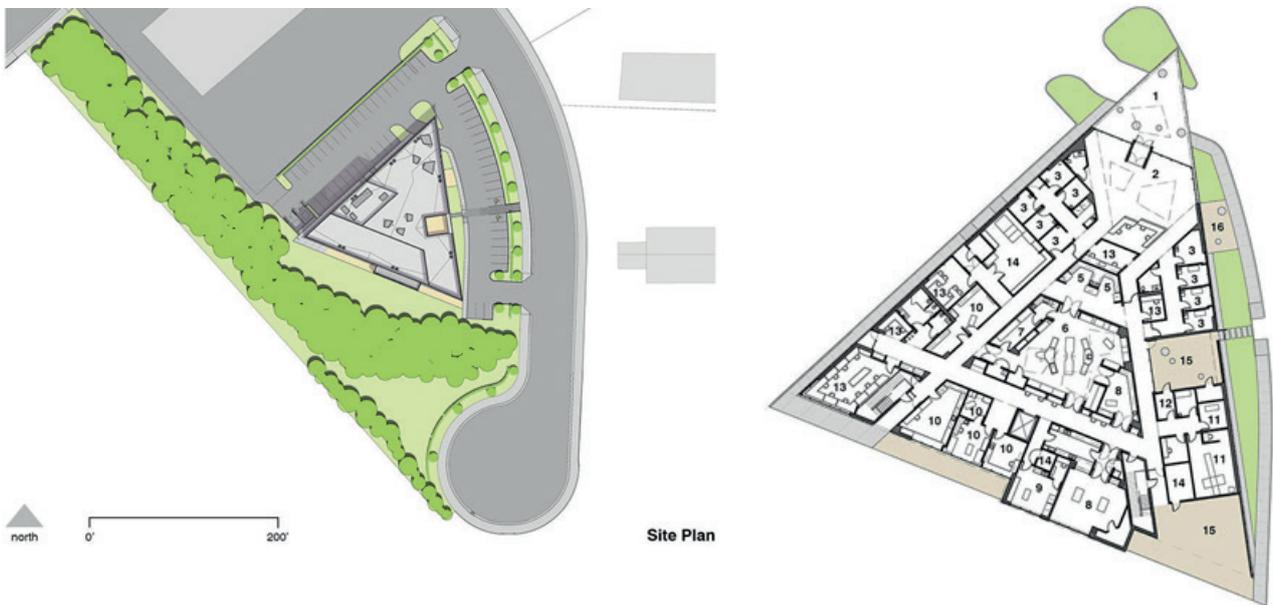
Генеральный план, совмещённый с планом кровли и план 1-го этажа [3]
